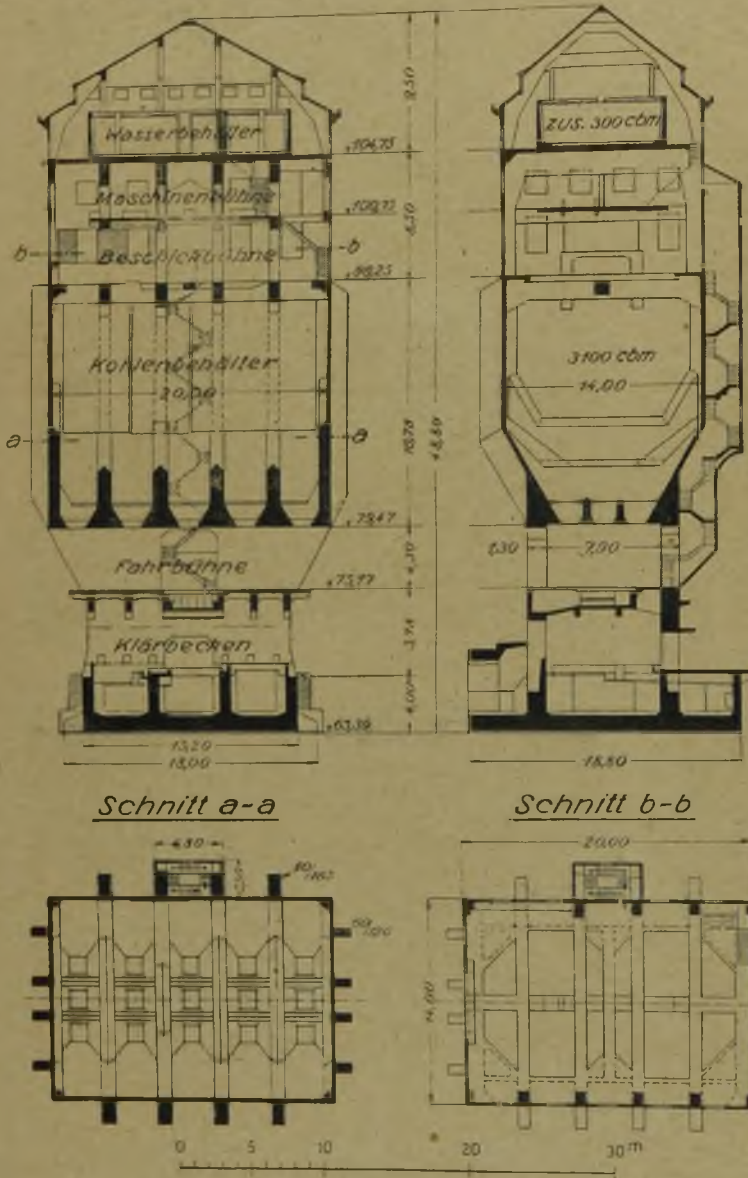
4. Schnitte und Grundrisse des Kokskohlenturms. Konstruktion und Ausführung: Wayss & Freytag A.-G.
